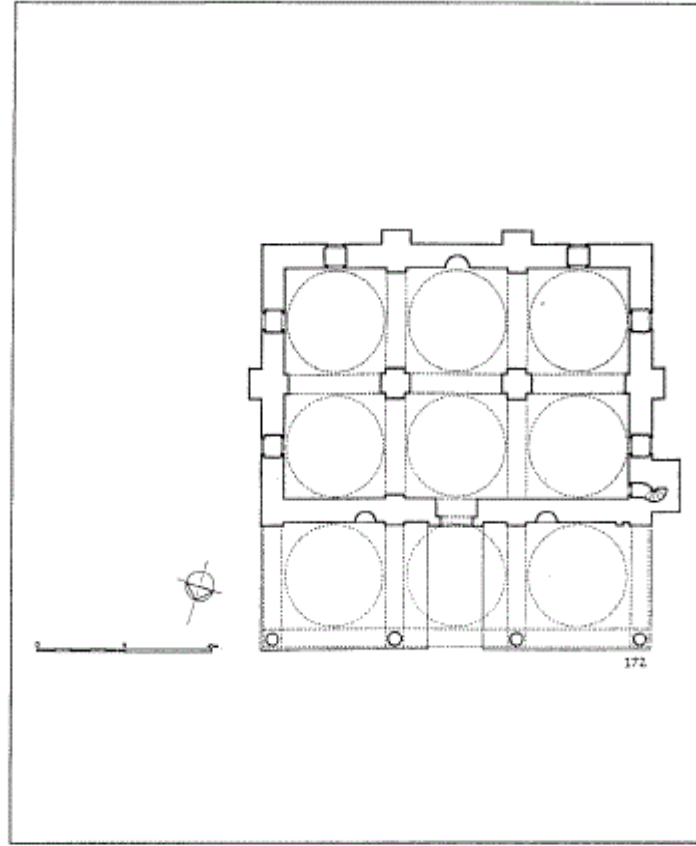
مسقط أفقي للمسجد العتيق أو القديم (اسكى جامع) في أدرنة (عن :
